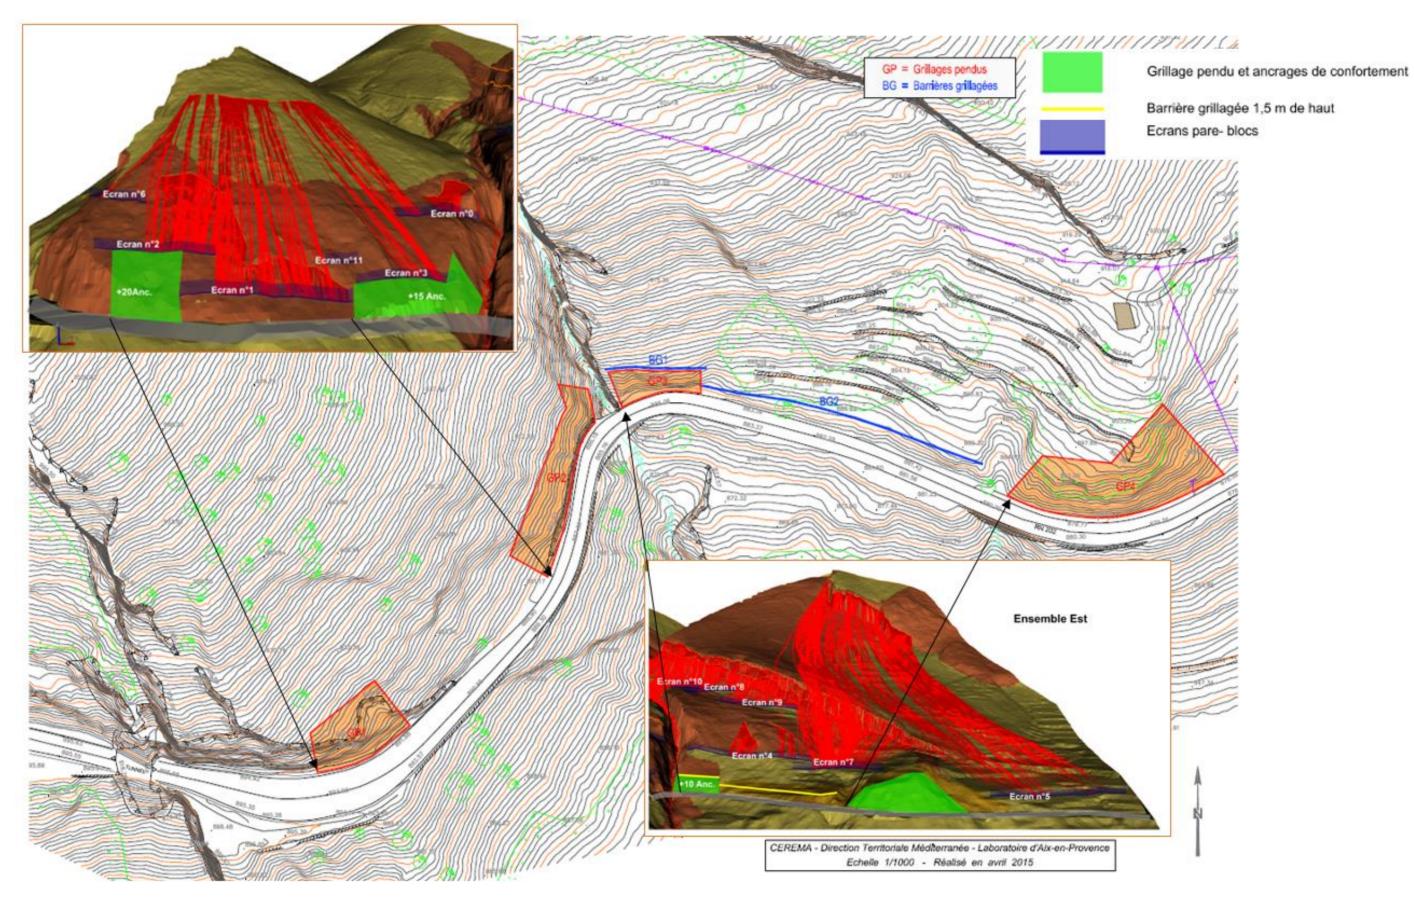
Schéma d'implantation des barrières sur la base du plan topographique (Source : CETE, 2011)
